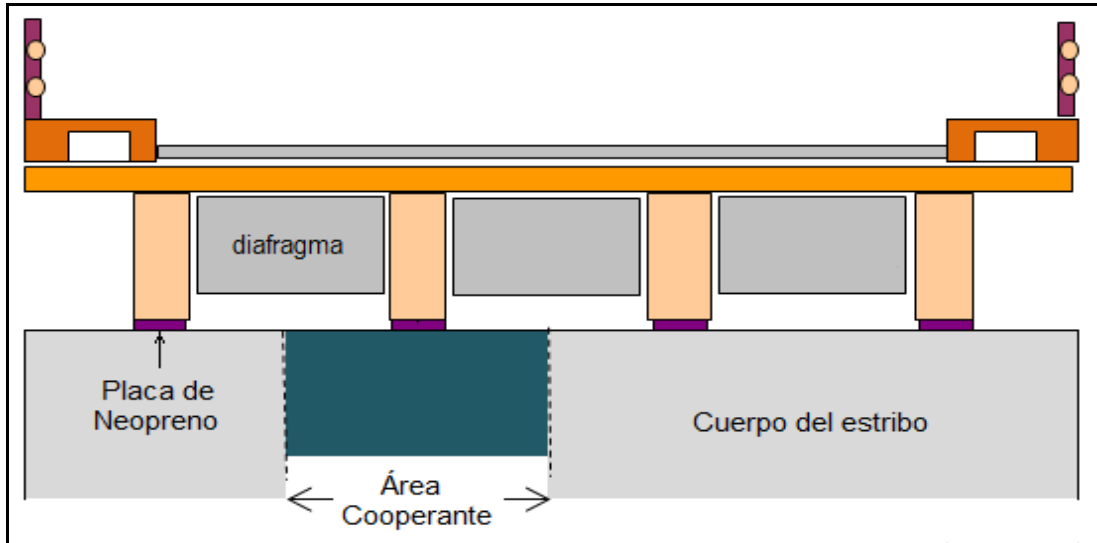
Sección Transversal del puente Machángara con vigas de Hormigón Armado
